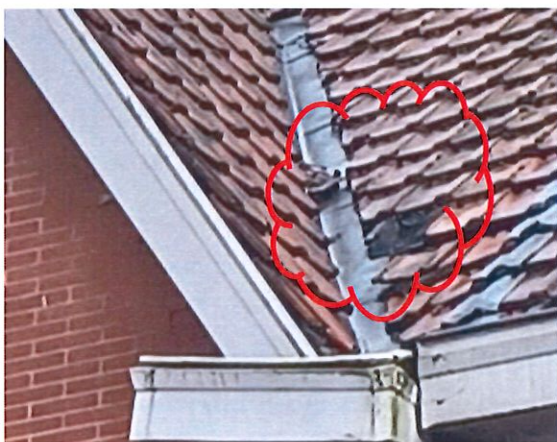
schade enkelzijdig gelopen naar de gemeenschapsruimte tralie
